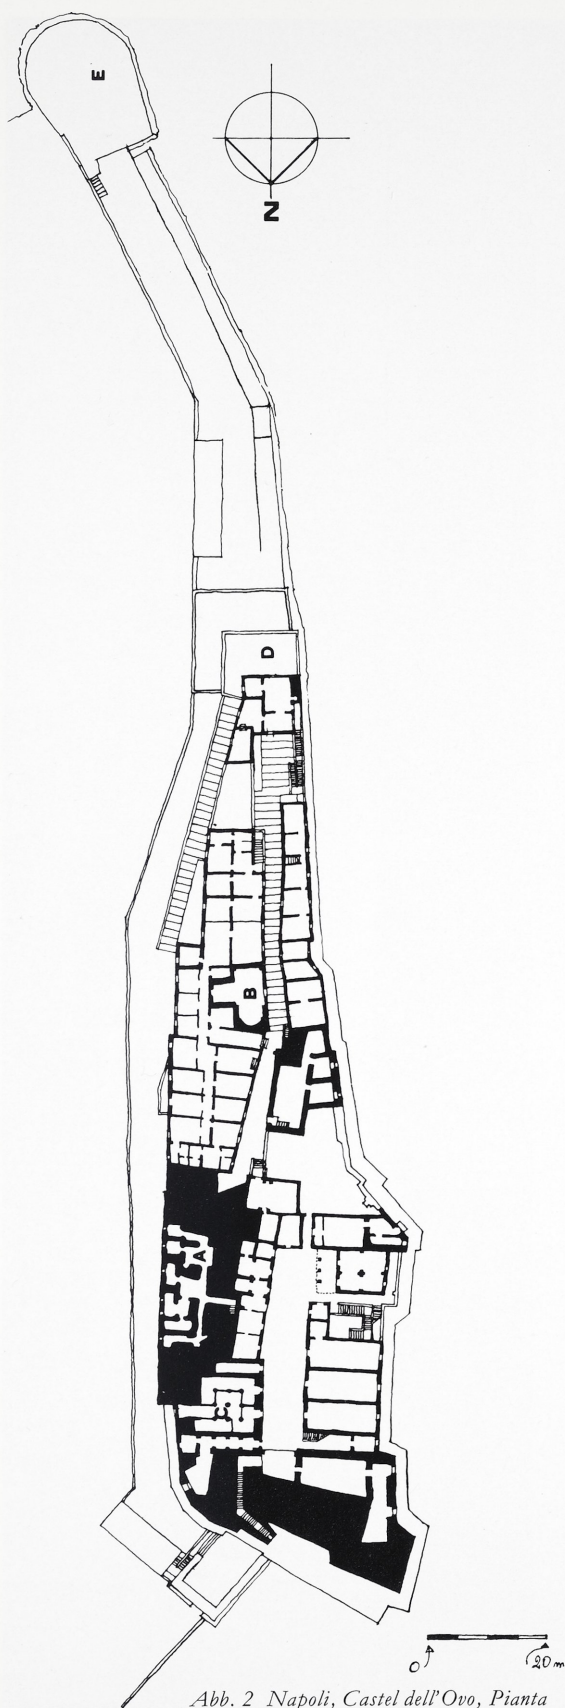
Napoli, Castel dell'Ovo, Pianta
